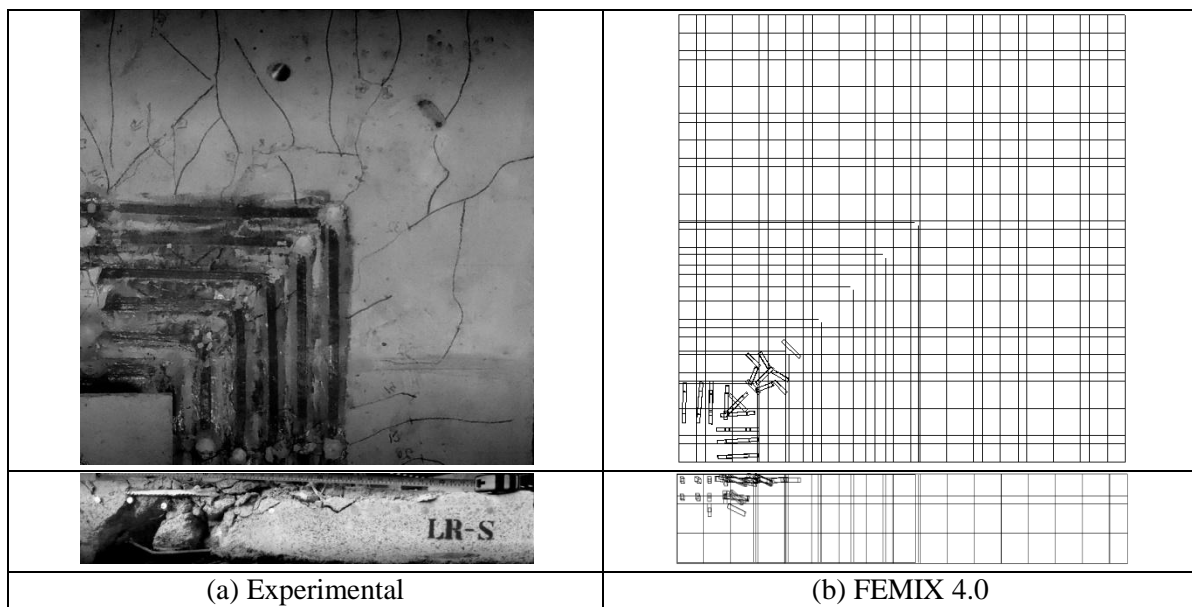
Padrão de fissuração - LR-S (FEMIX 4.0)
